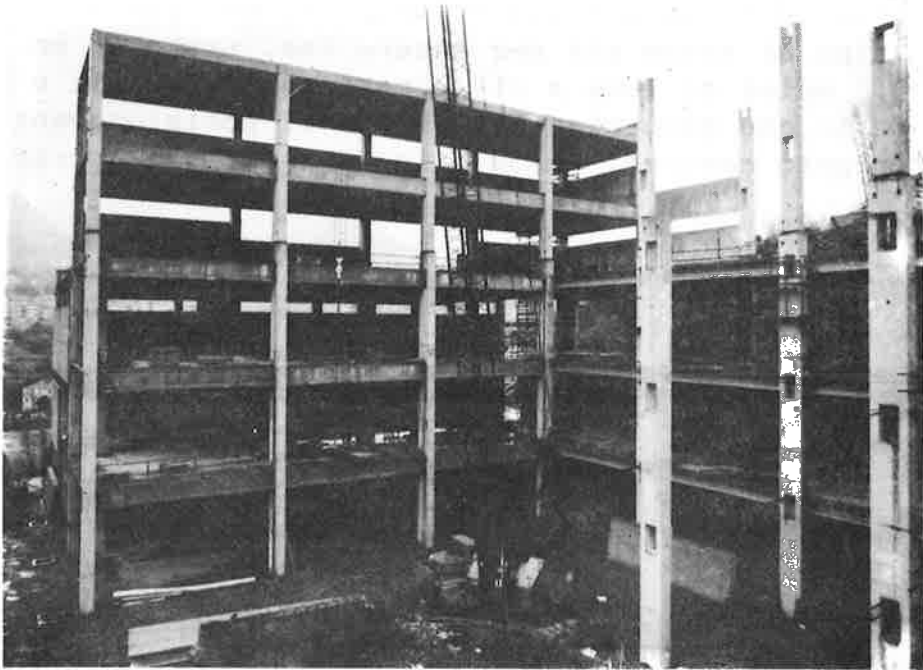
Montaggio dell'edificio pluripiano con pilastri giuntati di Via Gualco a Genova.
